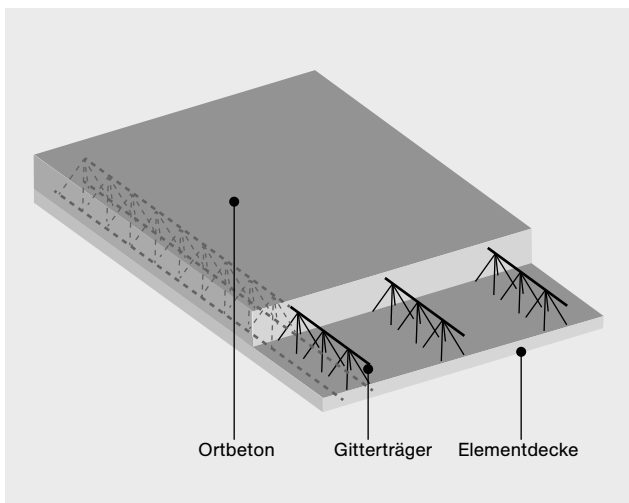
Schematischer Aufbau einer Deckenplatte aus Elementdecke mit Gitterträgern und Ortbetonergänzung
